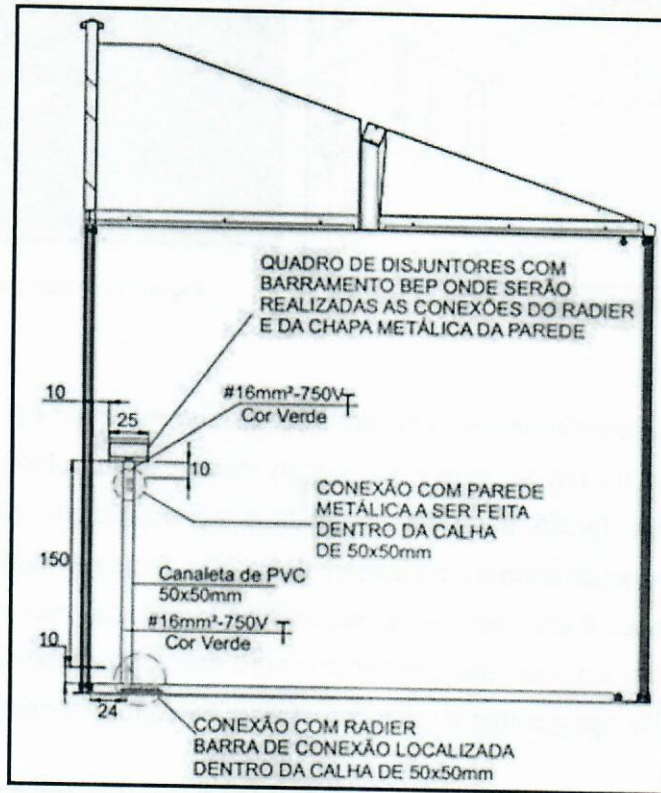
Conexão Barramento BEP x Radier x Chapa Metálica do Painel
